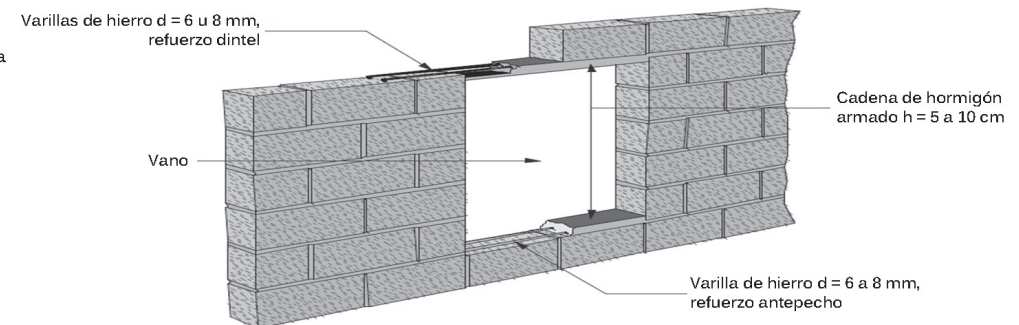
Detalle de refuerzos en dinteles y antepechos
